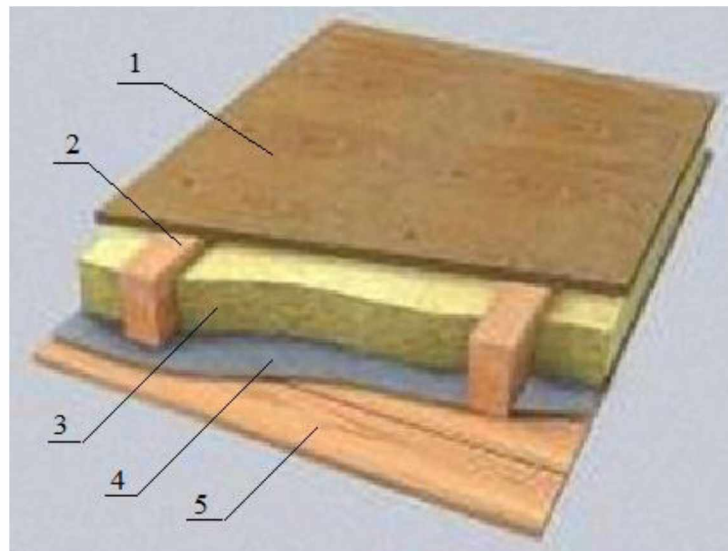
Технологічна схема утеплення перекриття горища
